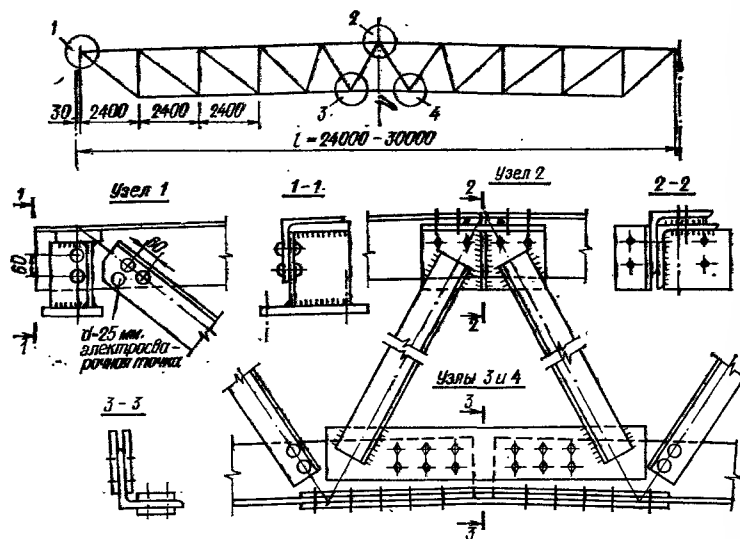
Узлы фермы из одиночных уголков со сварными соединениями проплавлением
